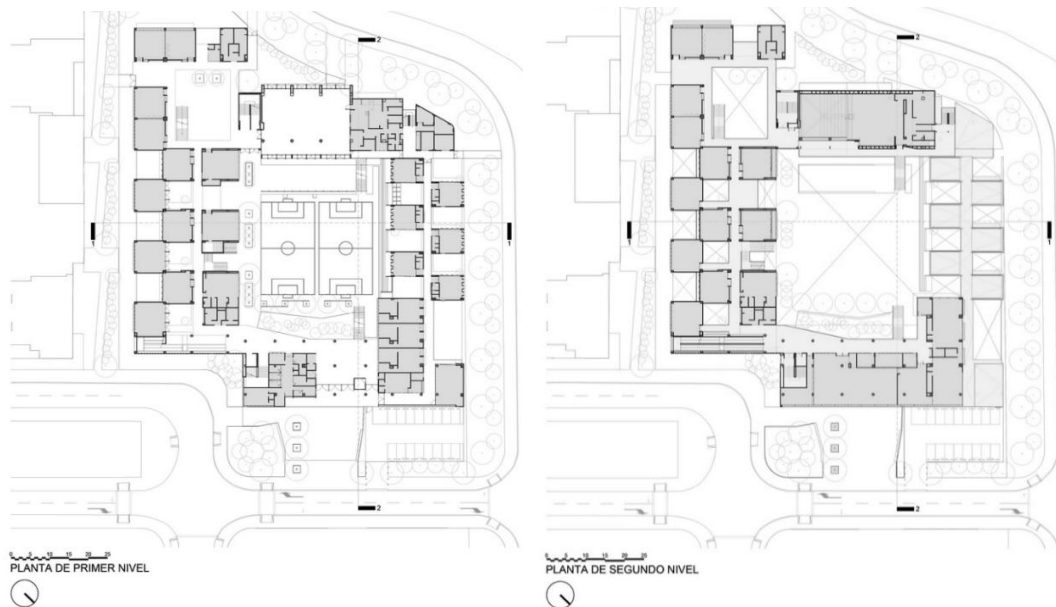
Y 8. Planta de primer nivel - Planta de segundo nivel
